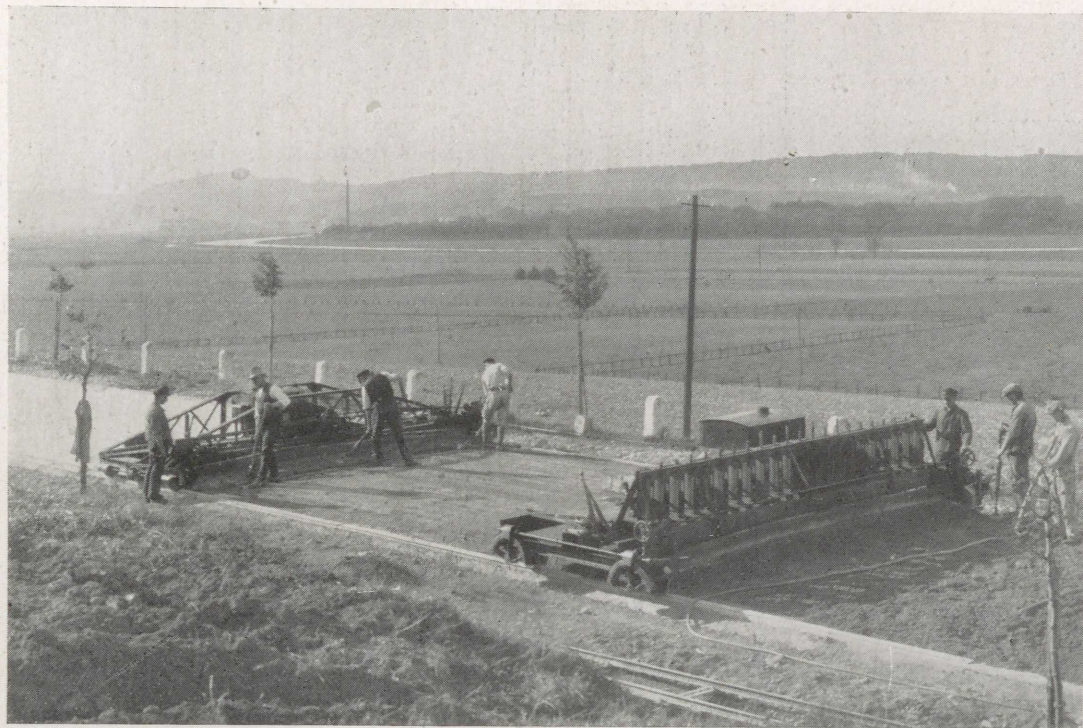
Rechts Hammerstampfmaschine, links Straßenfertiger zum Dichten und Glätten der Oberfläche
